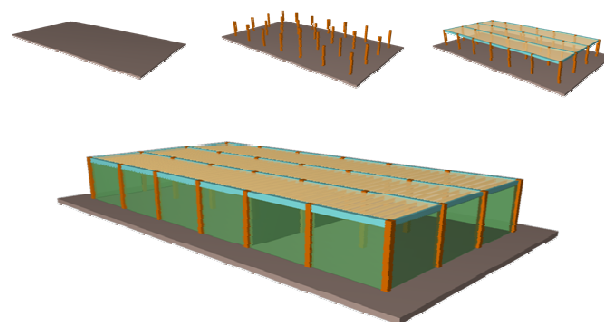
Estructura 3D - Fases constructivas y diseño final
